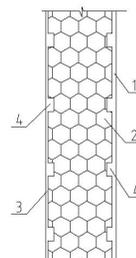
保模一体板 (无机芯材) 构造示意图
